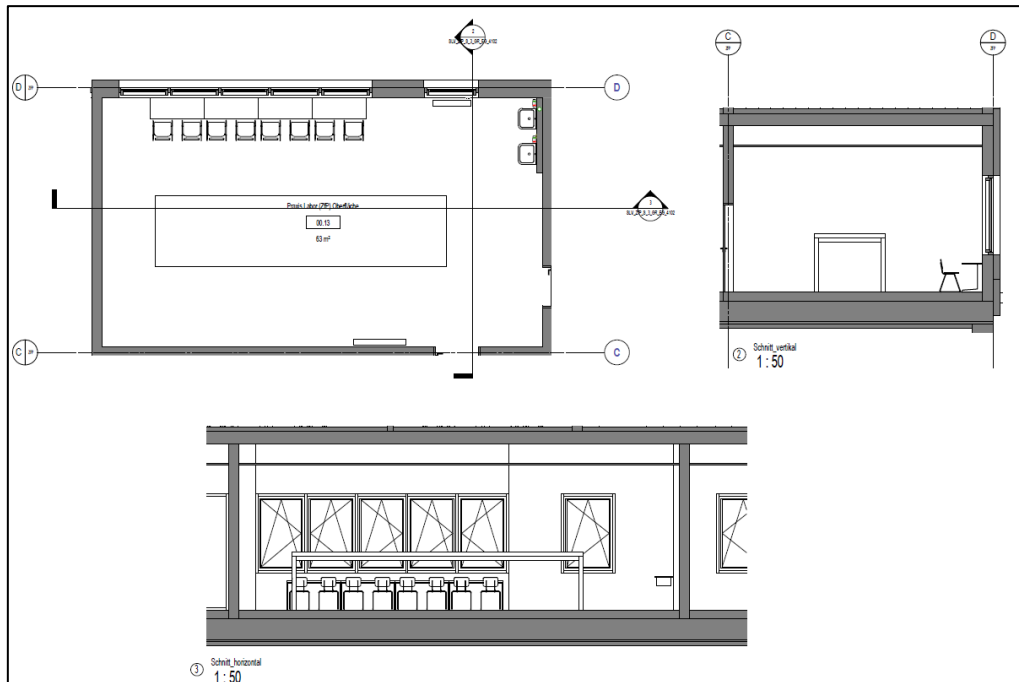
Grundriss und Schnitte des zu betrachtenden Laborraums
